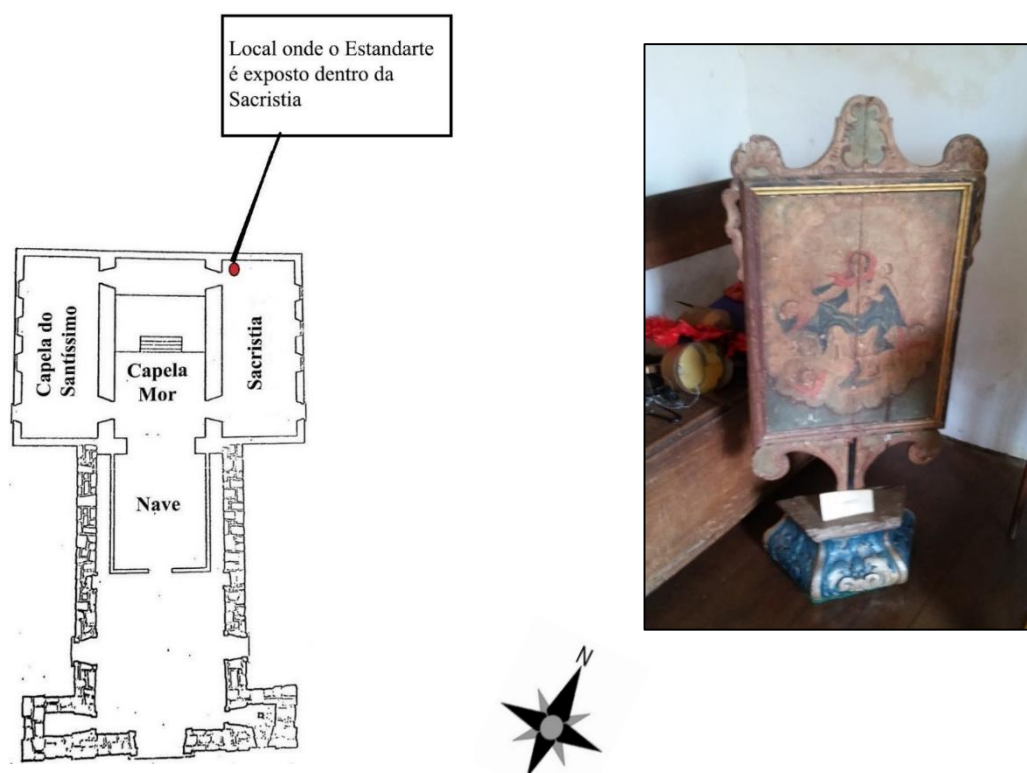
Planta baixa indicando local onde Estandarte está exposto próximo a parede, acoplado improvisadamente em uma base de madeira sobre o chão
